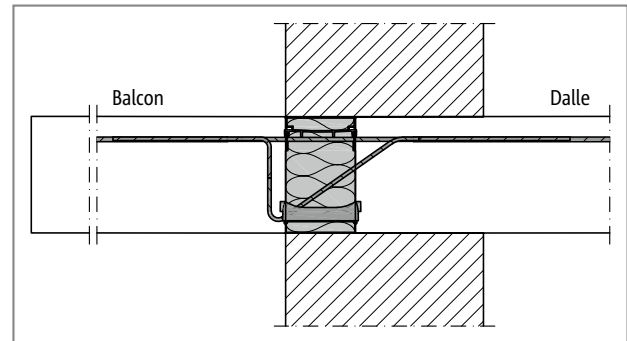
Schöck Isokorb® T Type K : Raccordement sur maçonnerie monocoque
